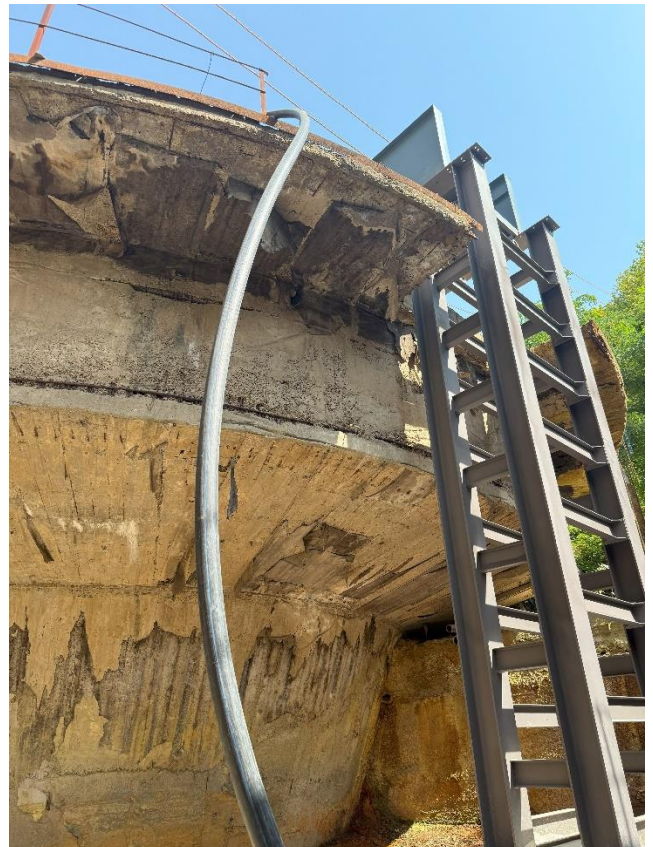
Разрушение наружной гидроизоляции чаши. Разрушение
